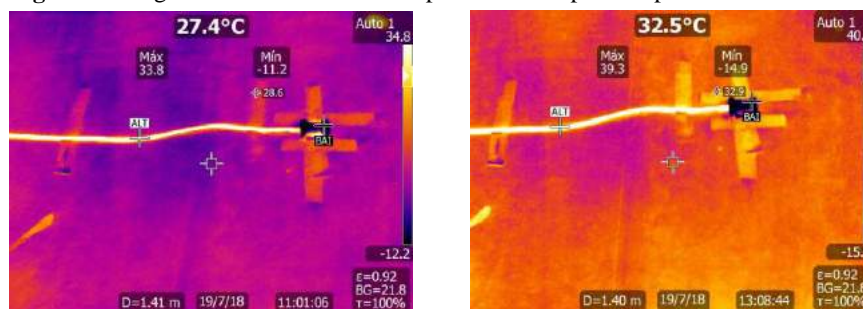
Imagens em infravermelho do pavimento no período da manhã.
